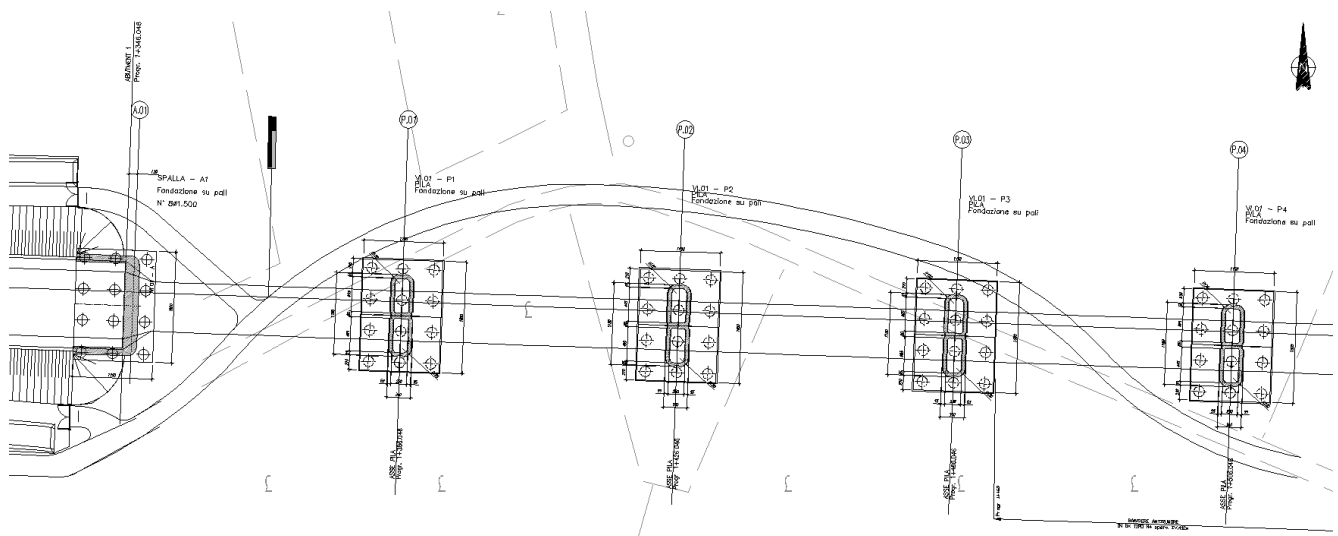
Pianta fondazioni - Ponte a struttura mista acciaio calcestruzzo a doppio binario
